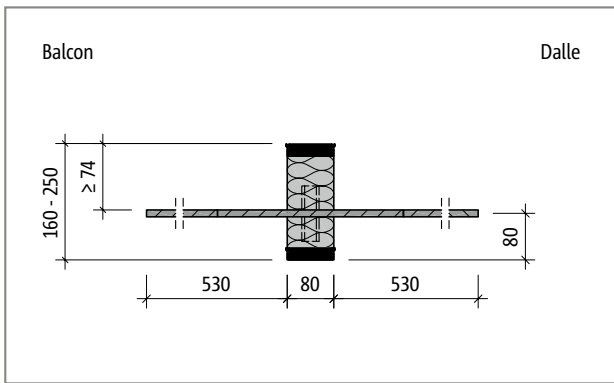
Schöck Isokorb® T Type H-NN2 : Coupe du produit
